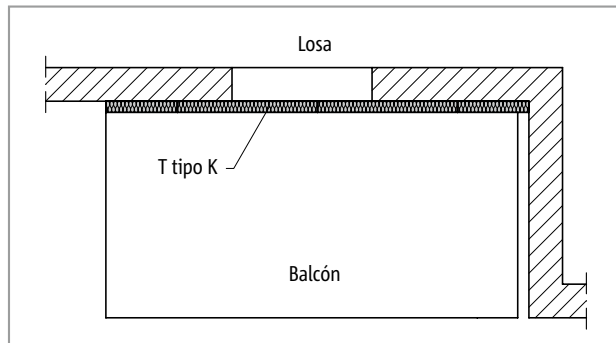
Schöck Isokorb® T tipo K: Balcón en fachada saliente
